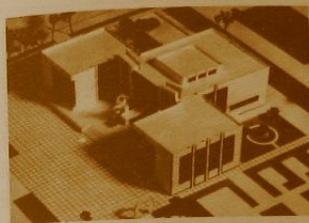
Планувальні схеми початкових шкіл на 12-18 класів
